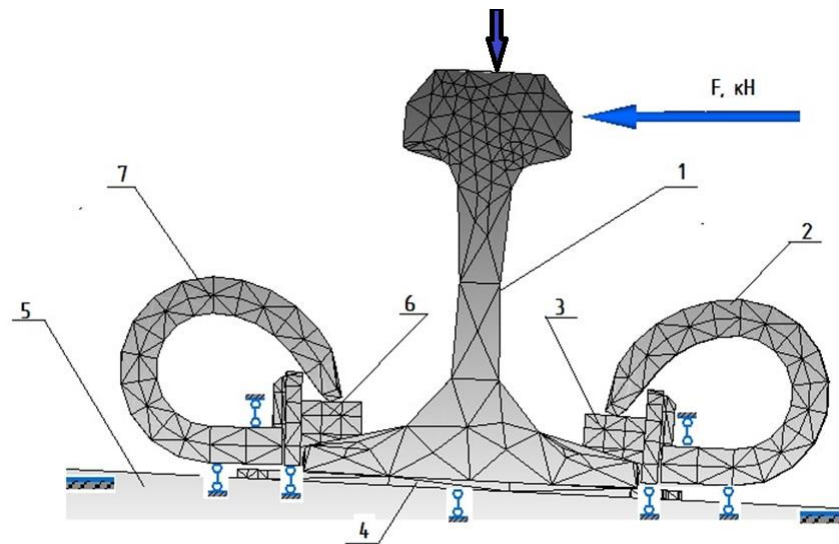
Розрахункова схема вузла рейкового скріплення типу КПП-5:
